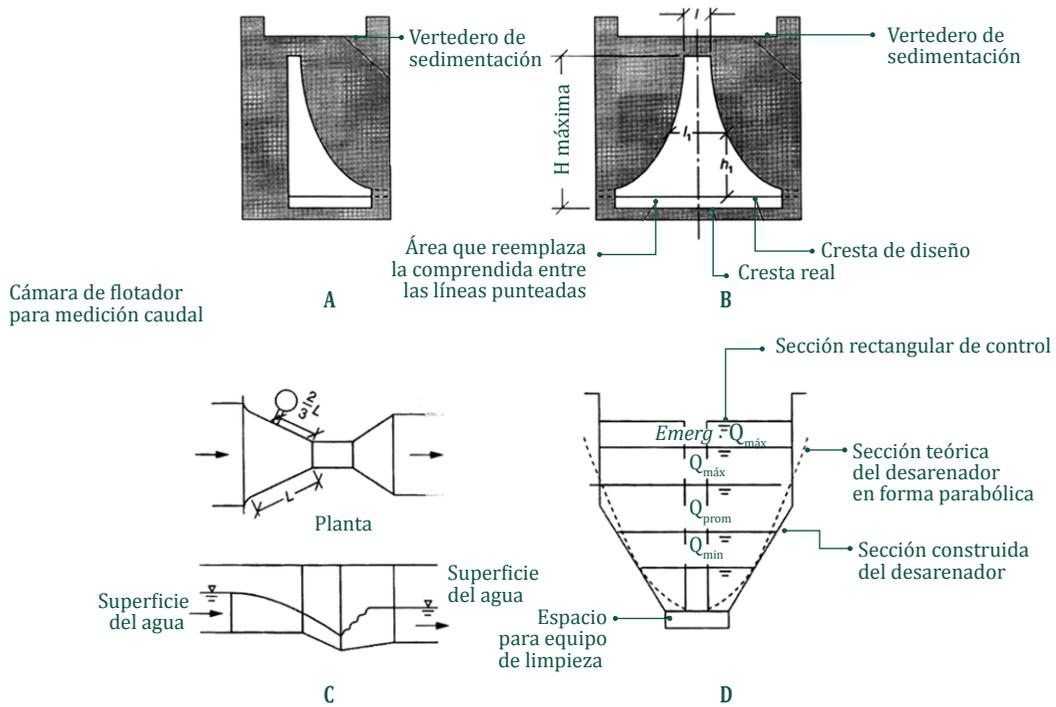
Vertederos Sutro en canales desarenadores de flujo constante (del Río, 2018).
